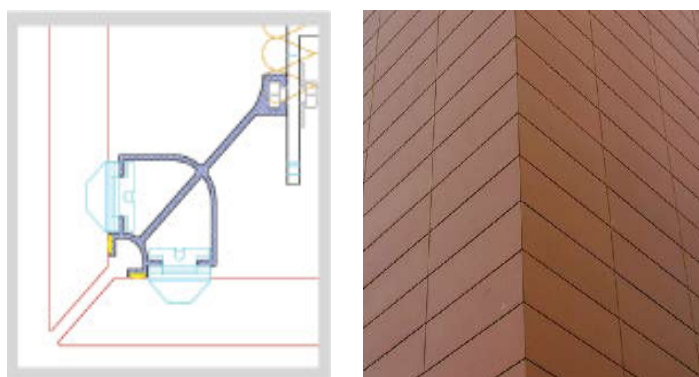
Aplicação da fachada ventilada – Canto com chanfre a 45° [47]
